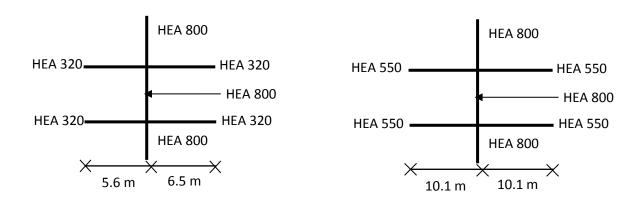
La rigidité du poteau HEA800 sens Z-Z et Y-Y.
